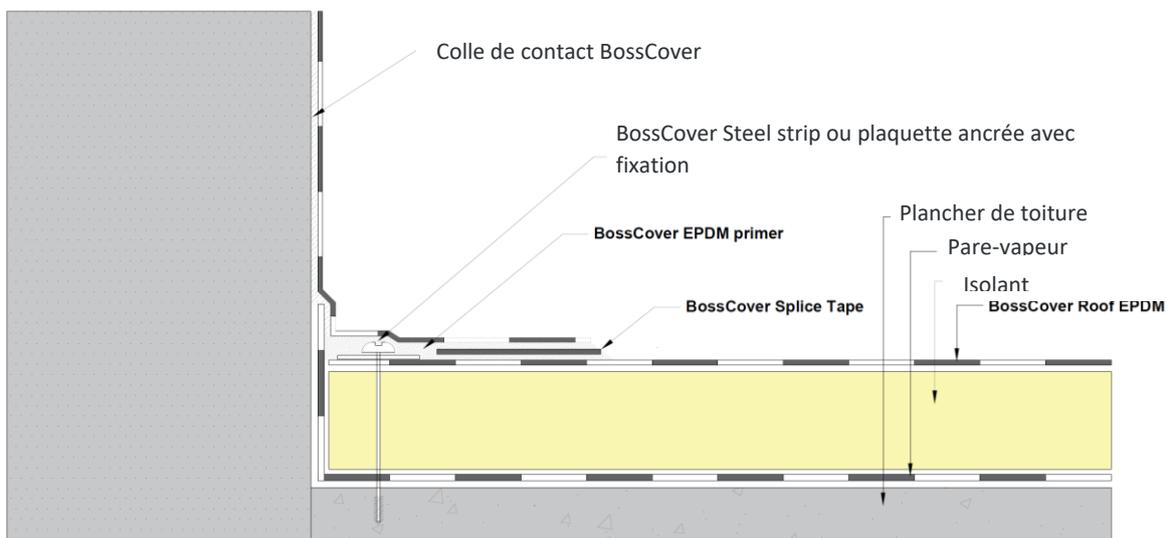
Fixation au droit de l'angle de l'acrotère au moyen d'une bande BossCover Perimeter Strip - Fixation horizontale dans le plancher de toiture et fixation verticale dans l'acrotère
